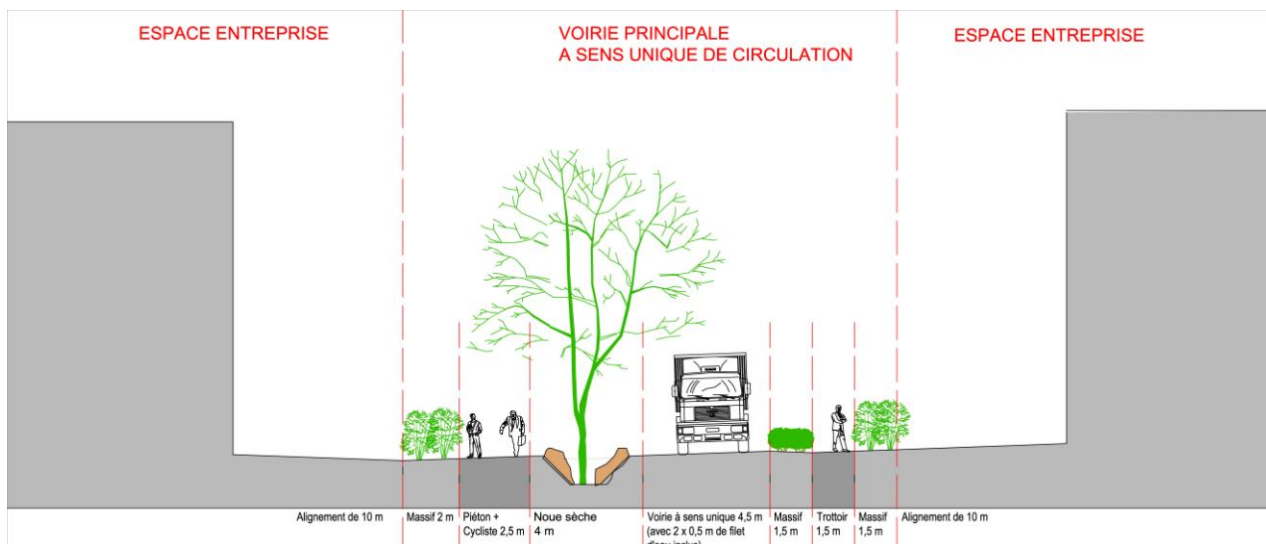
coupe type du profil de voirie ayant un seul sens de circulation et des plantations en alignement sur un bas-côté.
